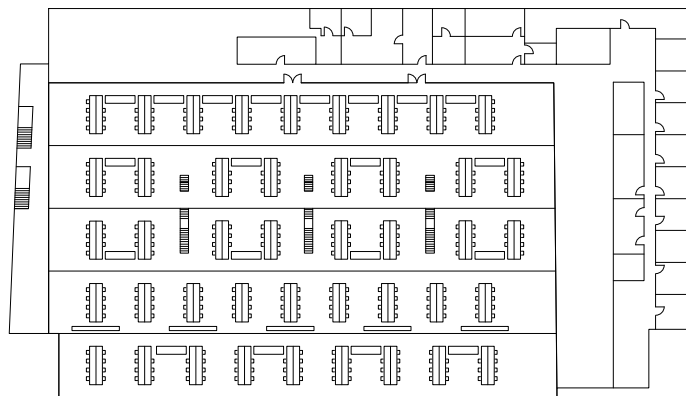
KAAAN Architekten, Bibliothek und Akademie der Darstellenden Künste, Plan, Erdgeschoss
